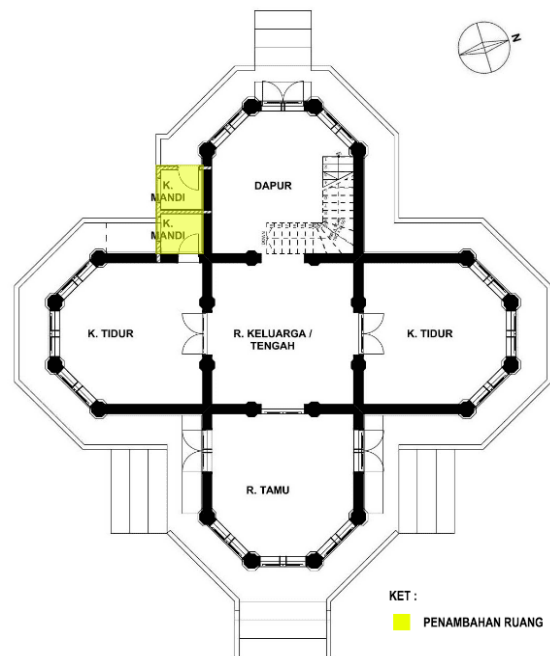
Gambaran Denah Lantai 2 Berdasarkan Wawancara
